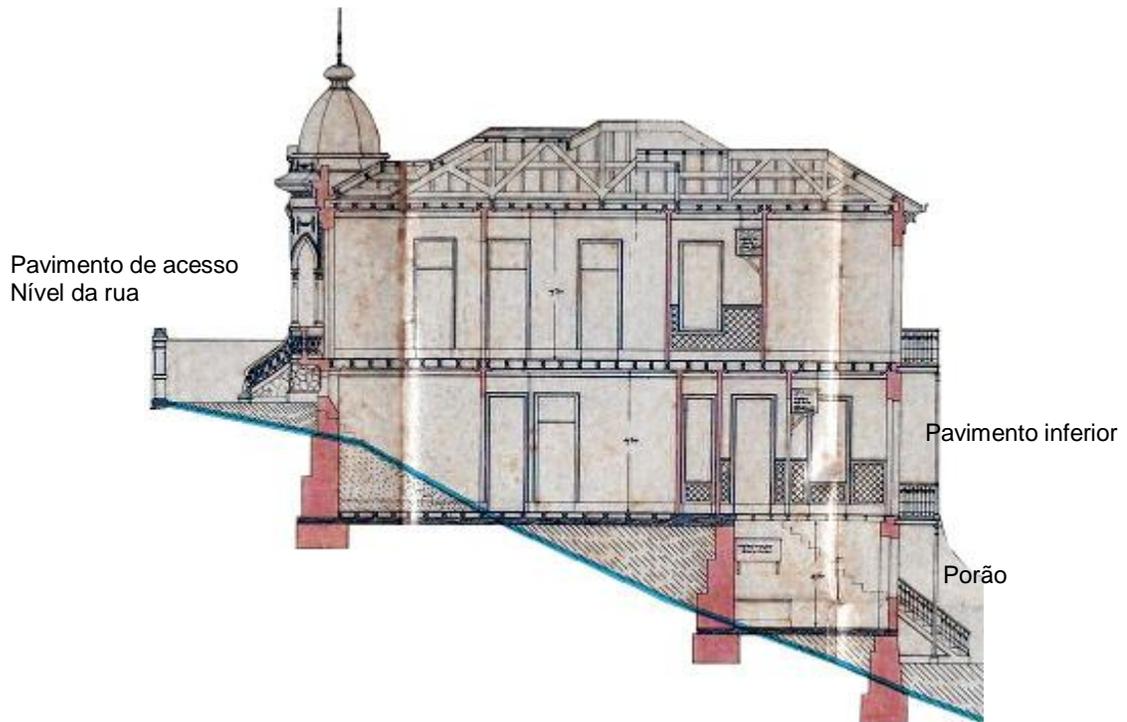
Corte longitudinal. A fachada vista da rua corresponde apenas ao pavimento de acesso.
